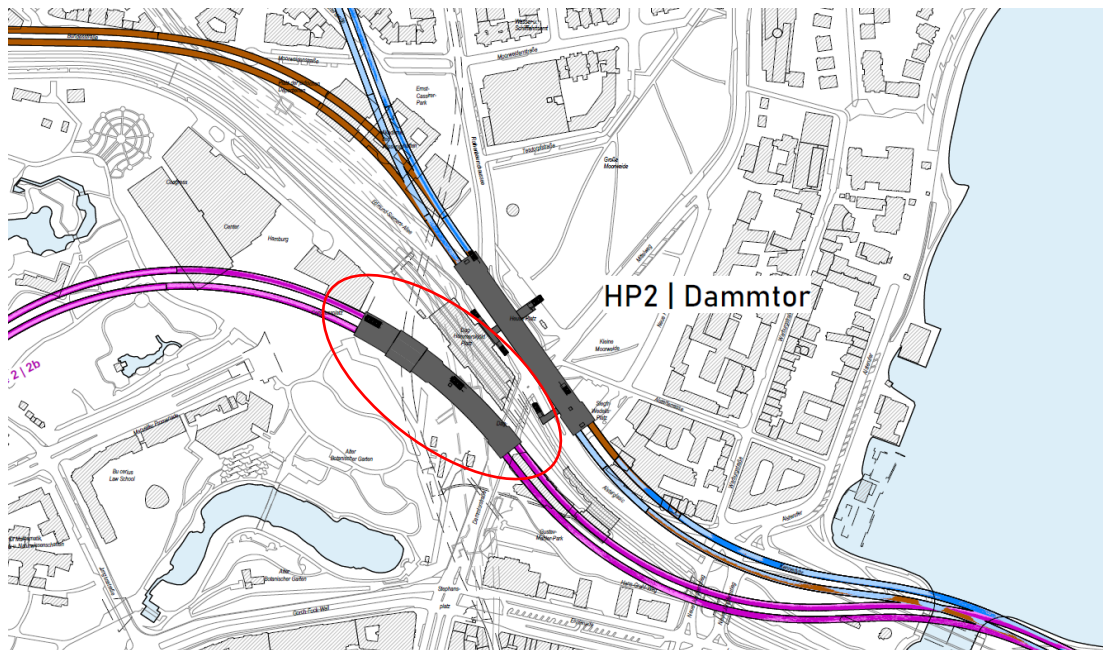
Lageplan Stationsbauwerk HP 2 Dammtor, Variante 2 (pink/lila), Station II (SW) (Variantenstudie).
